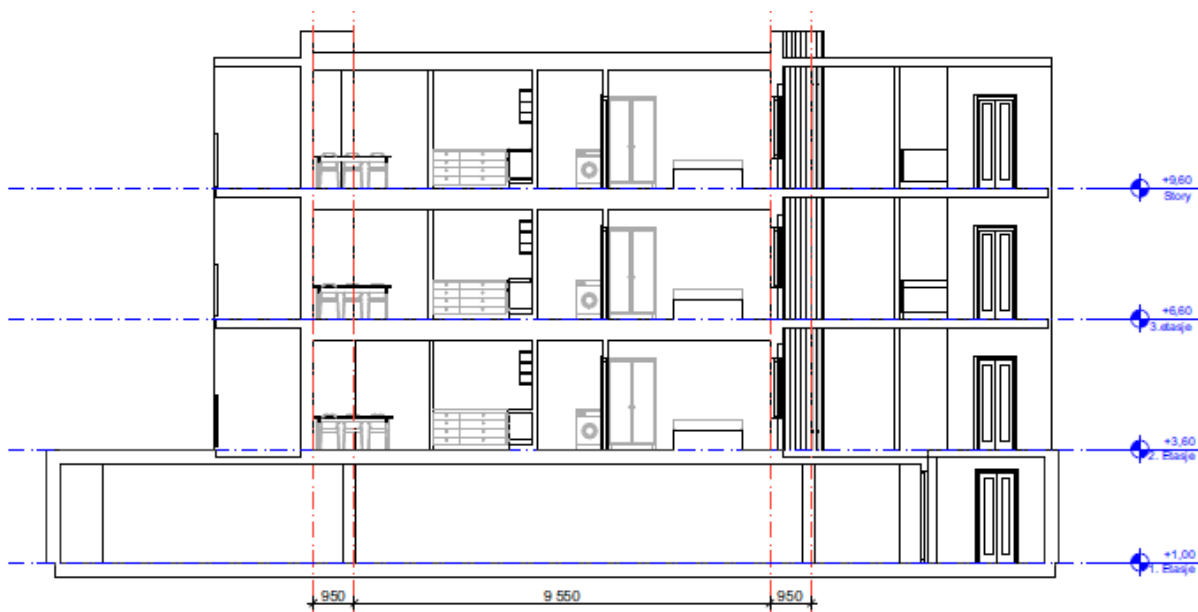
Illustrasjonsplan for Kalvtrøa 6.
